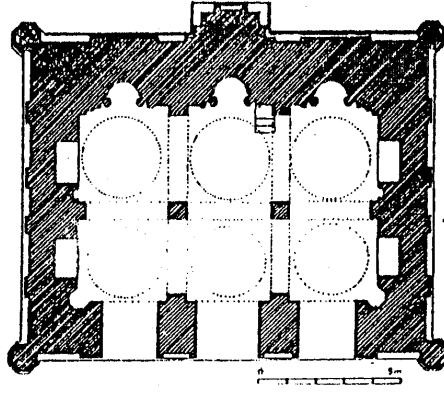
مسقط أفقي للمشهد القبلي بأسوان . (عن : Villard) .
